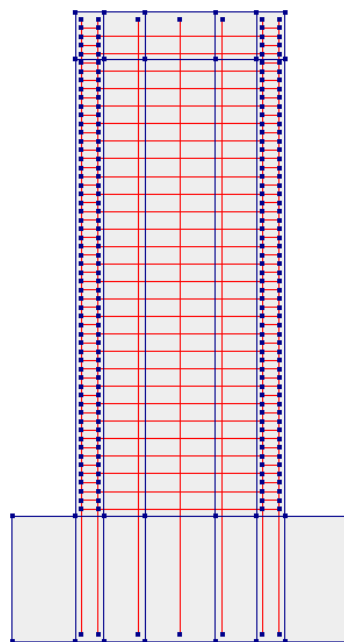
Modelado del acero de refuerzo para el muro D, se utilizan elementos tipo barra embebidos en los elementos de concreto.
